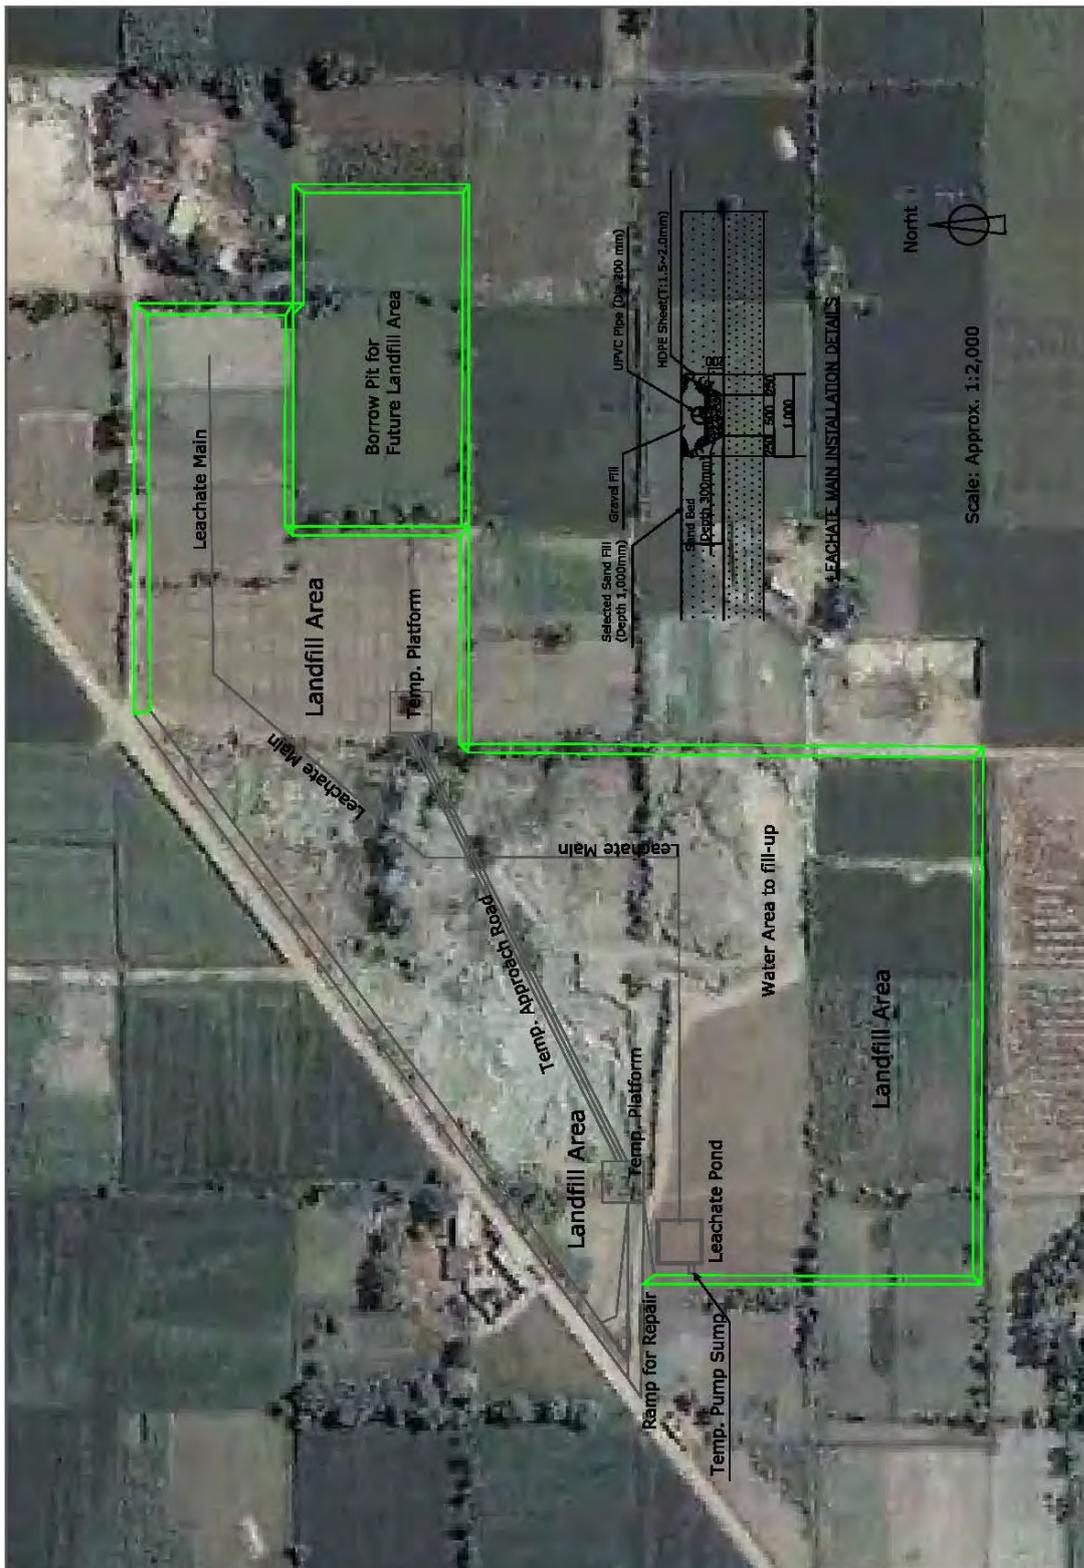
ゴンドランワラ埋立地の緊急改善計画平面図
